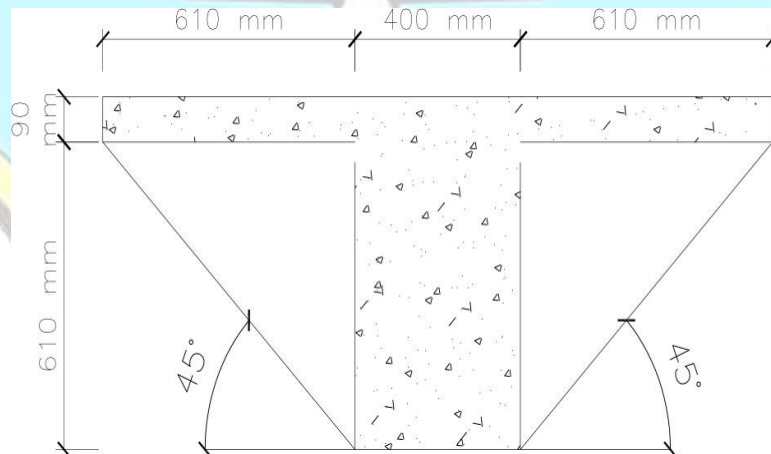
Denah Pelat Lantai Bagian III
